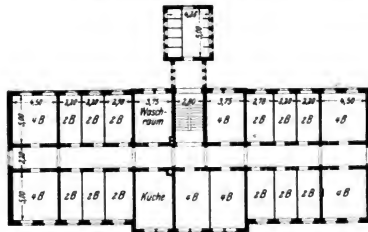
Übernachtungsgebäude in Wustermark. (Obergeschoß.)
